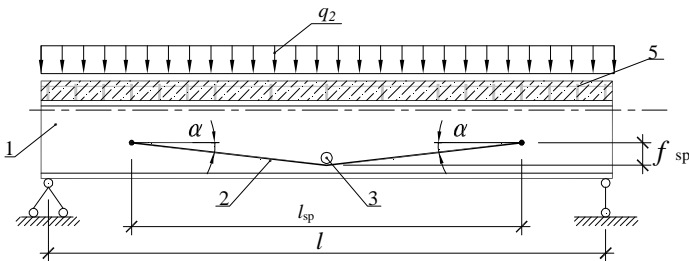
Сталежелезобетонная эксплуатируемая балка, усиленная локальным предварительным напряжением
